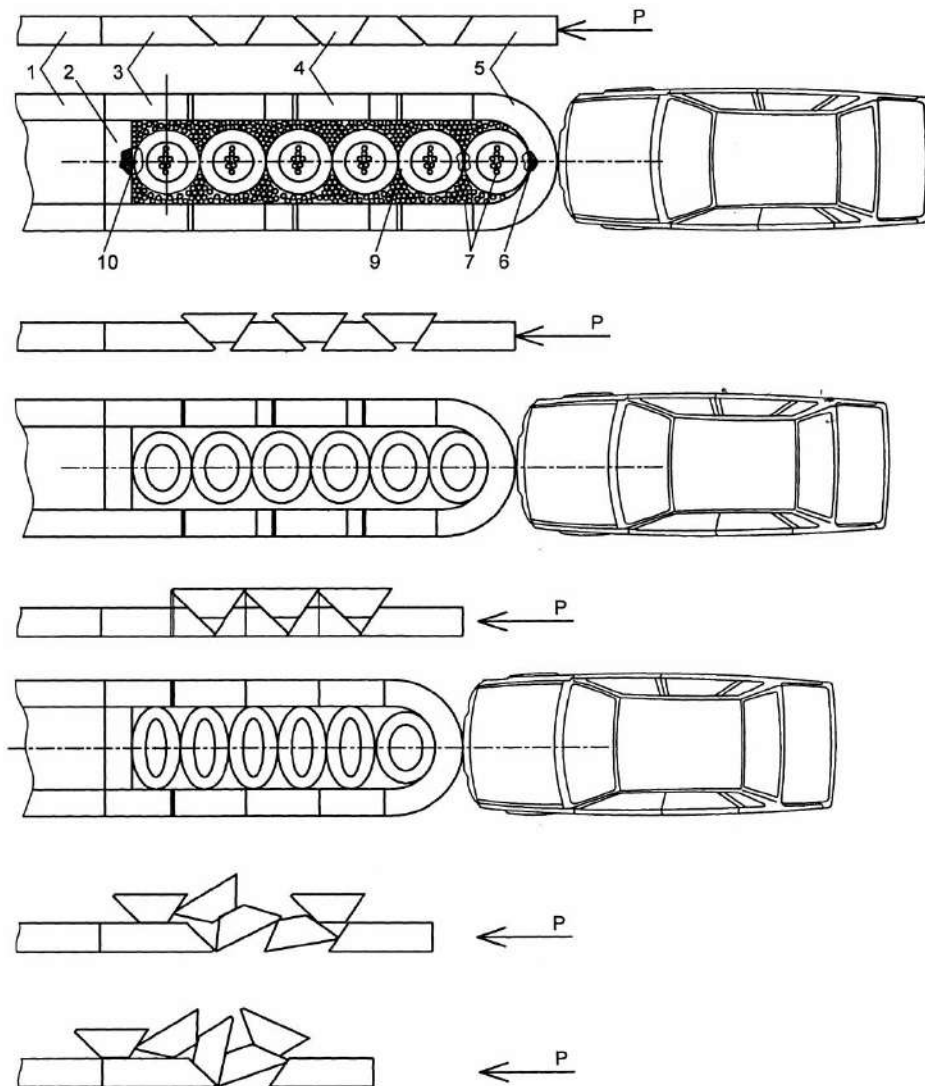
Механизм наезда автомобиля на разделительный барьер.
